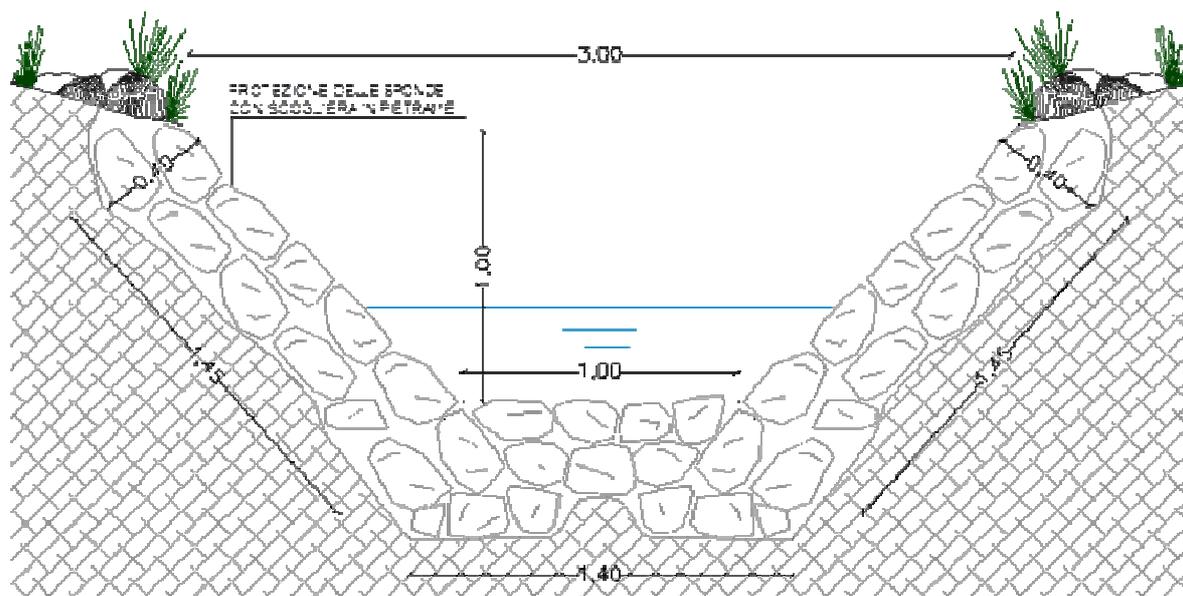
sezione trasversale dell'affluente Sud nel tratto iniziale presso SP 105 e presso confluenza nel ramo Est
